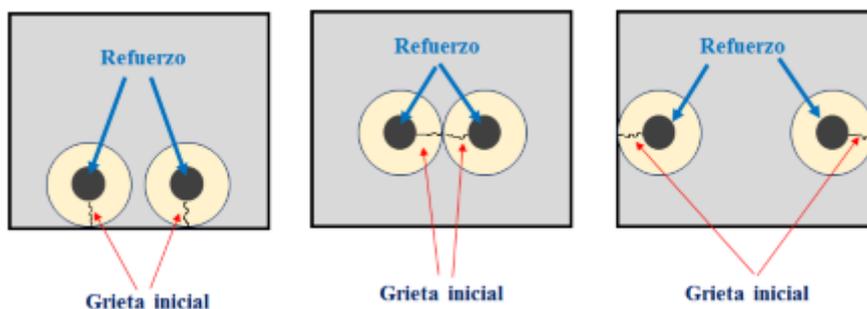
Grietas debido a los esfuerzos de adherencia acero-concreto.
